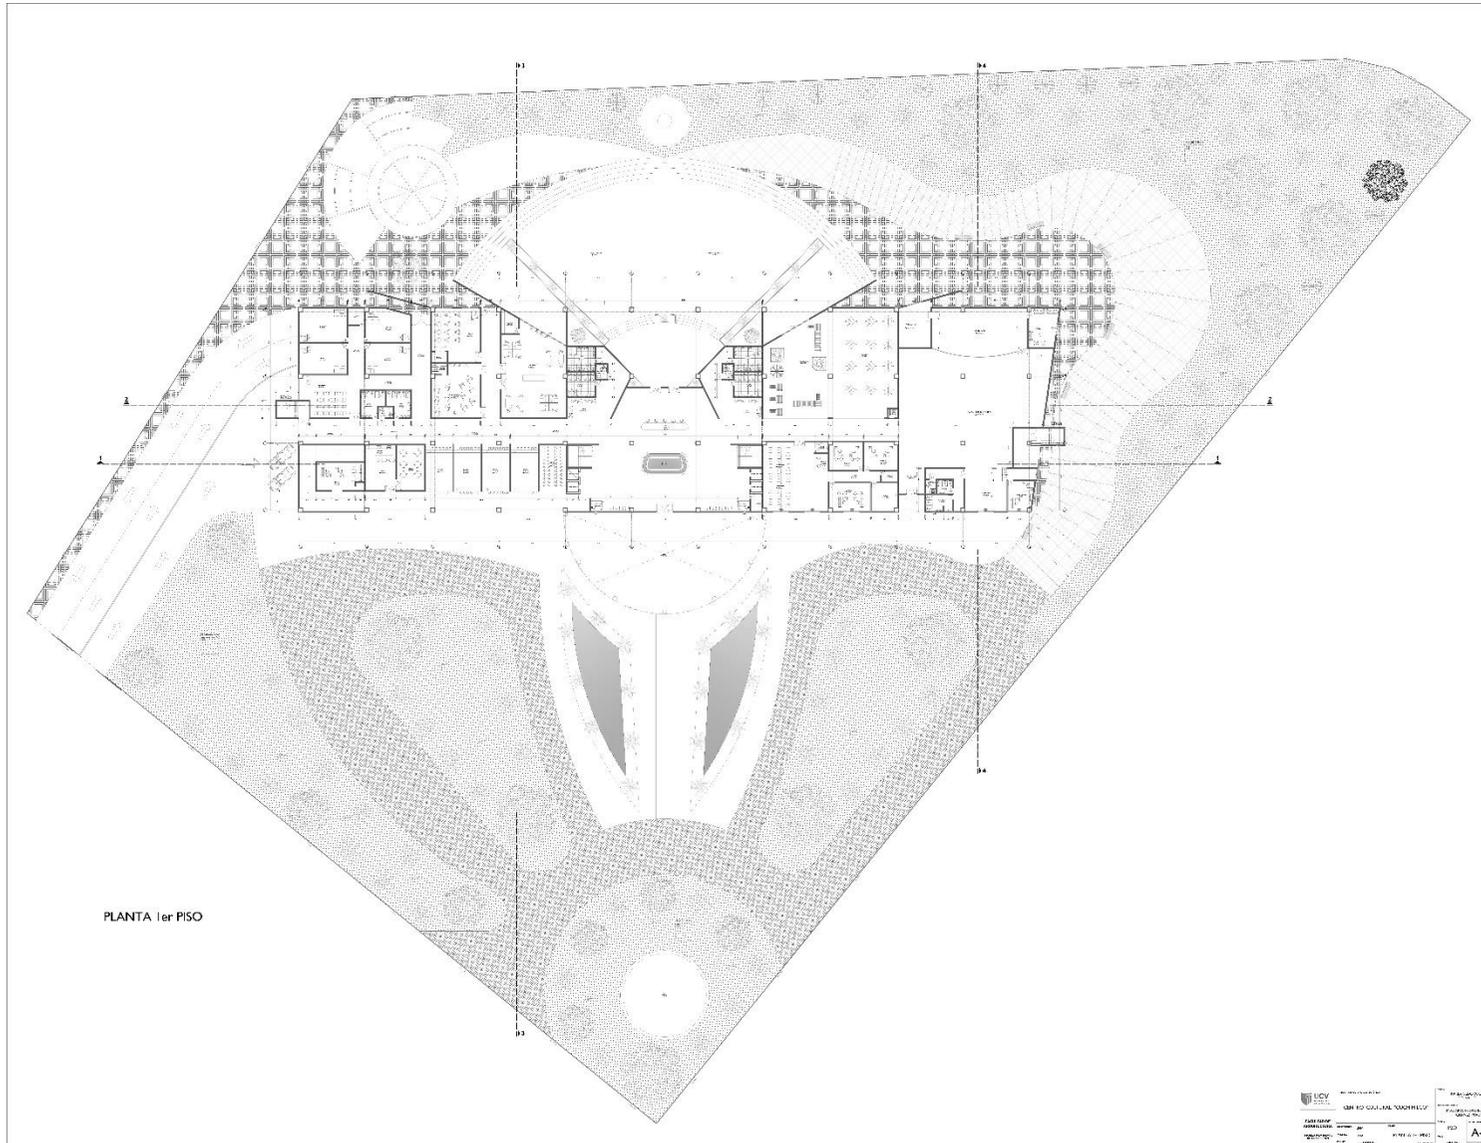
Plano de Arquitectura Planta 1er Piso. Elaboración propia
